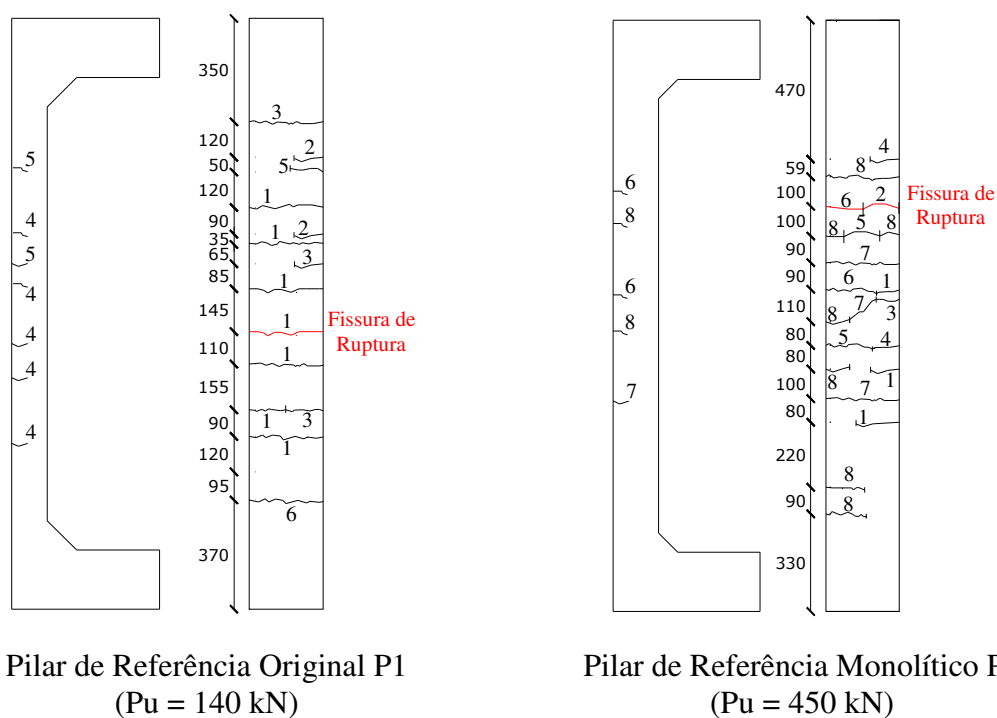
Mapa de fissuração dos pilares de referência P1 e P2
